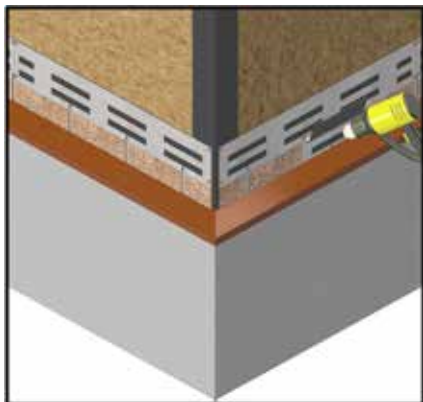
Прогрев клеевых полос фасадной плитки строительным феном.
